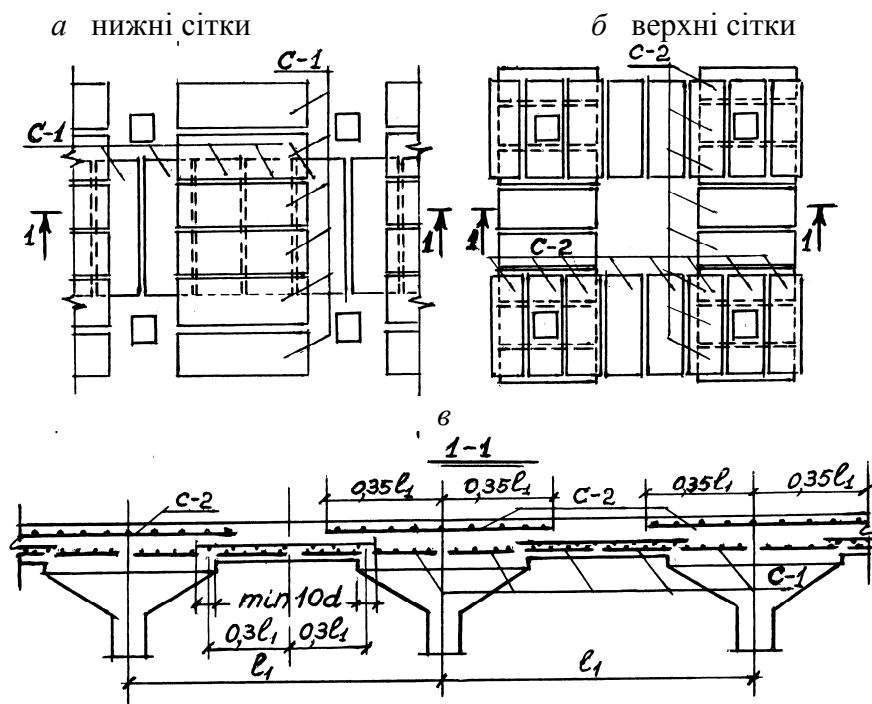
Армування безбалкового перекриття вузькими сітками:
